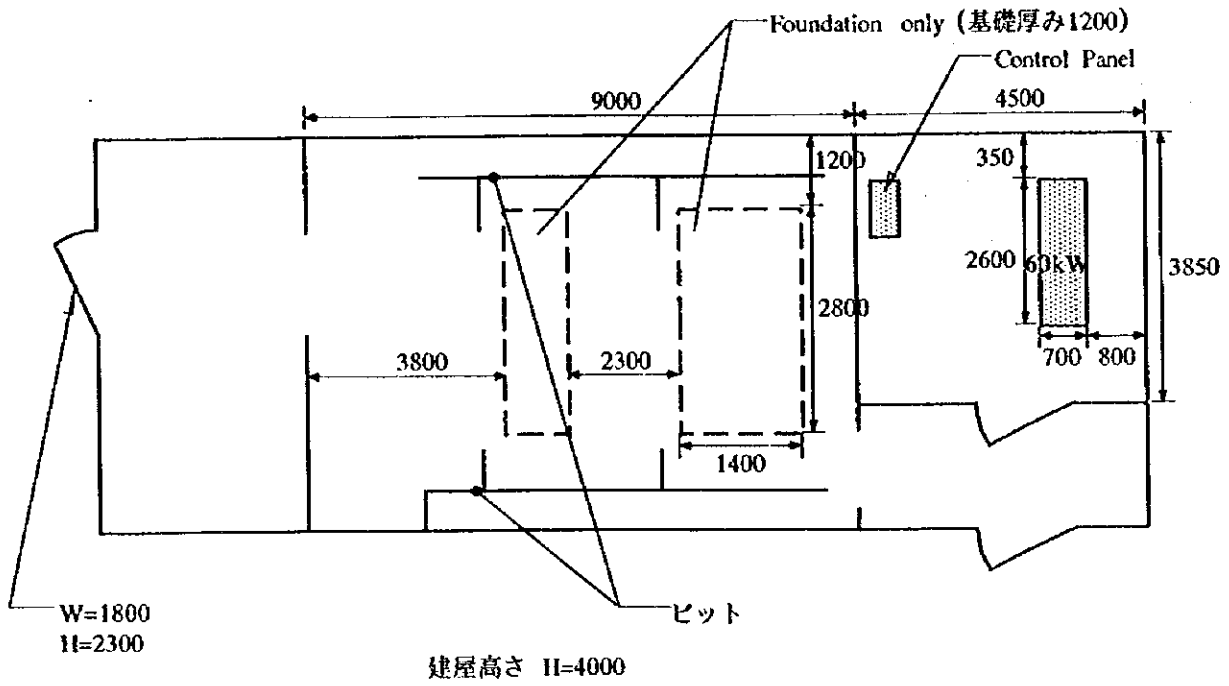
7 Tsagaankhairkhan村の機器配置図
